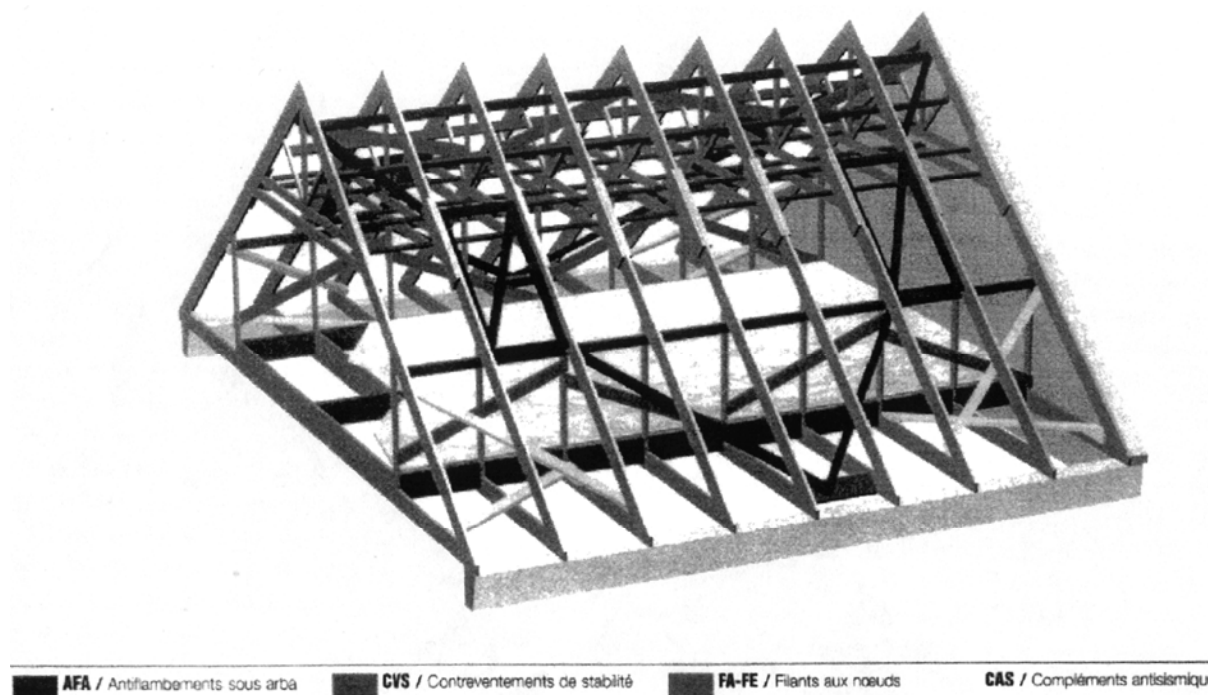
Contreventement de toiture. Cas de charpente de type fermette. Combles habitables. Diaphragme sur entrait. Schéma de principe.
